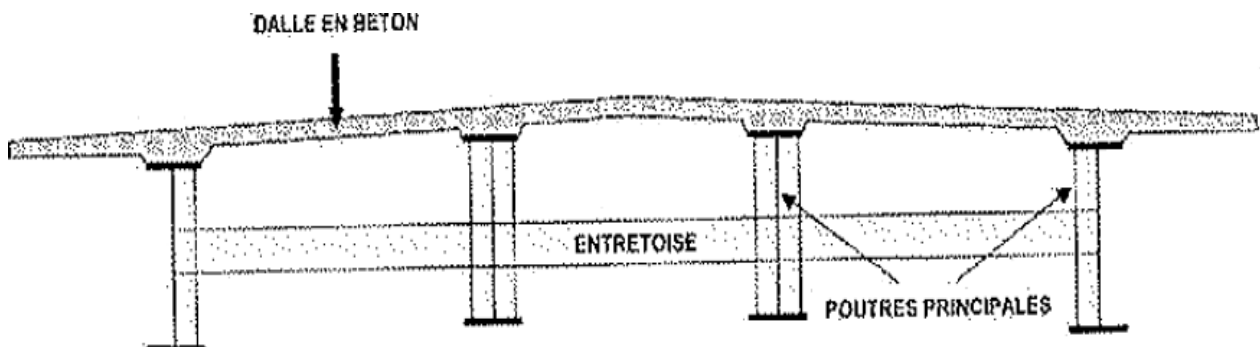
Pont multi poutres. Source : ponts mixtes acier-béton, Stéra.
